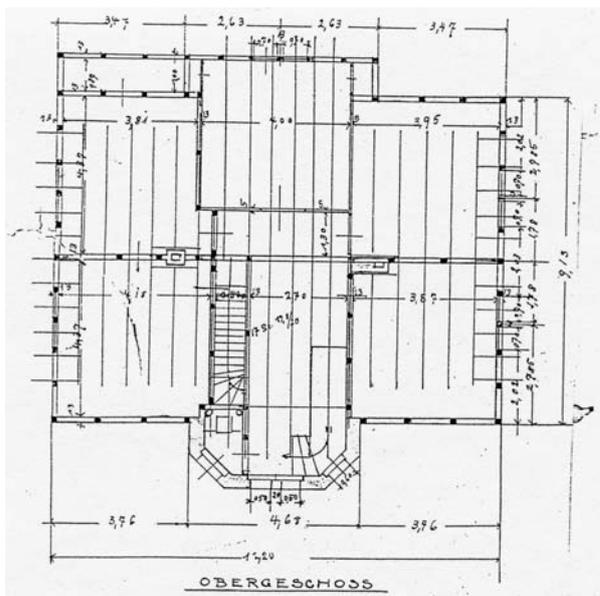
Sommerhaus H. Plange, Grundriss Obergeschoss, 1898
